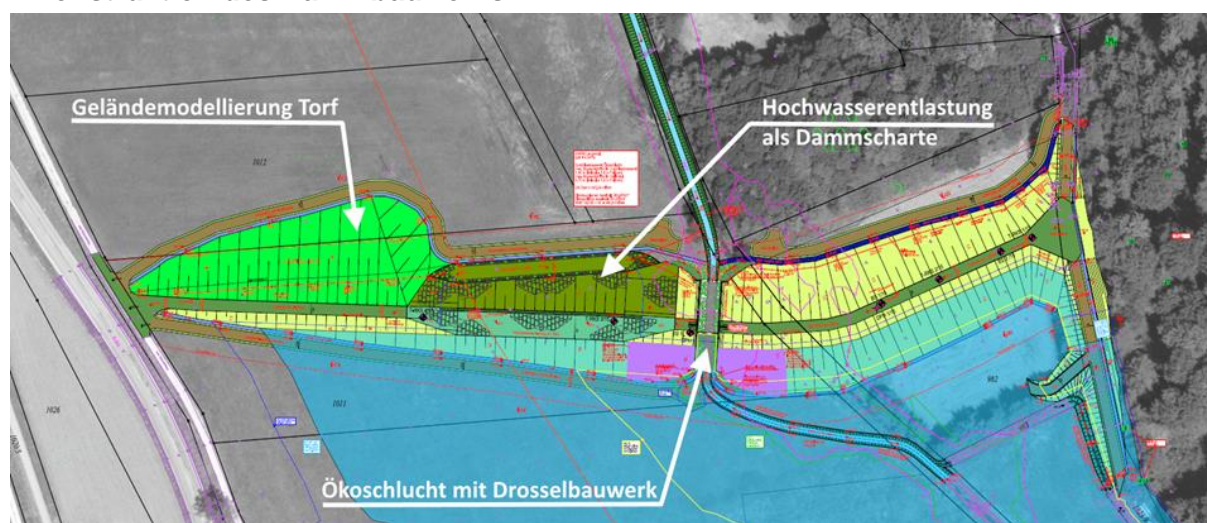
Detaillageplan Dammbauwerk, Quelle: Steinbacher-Consult
